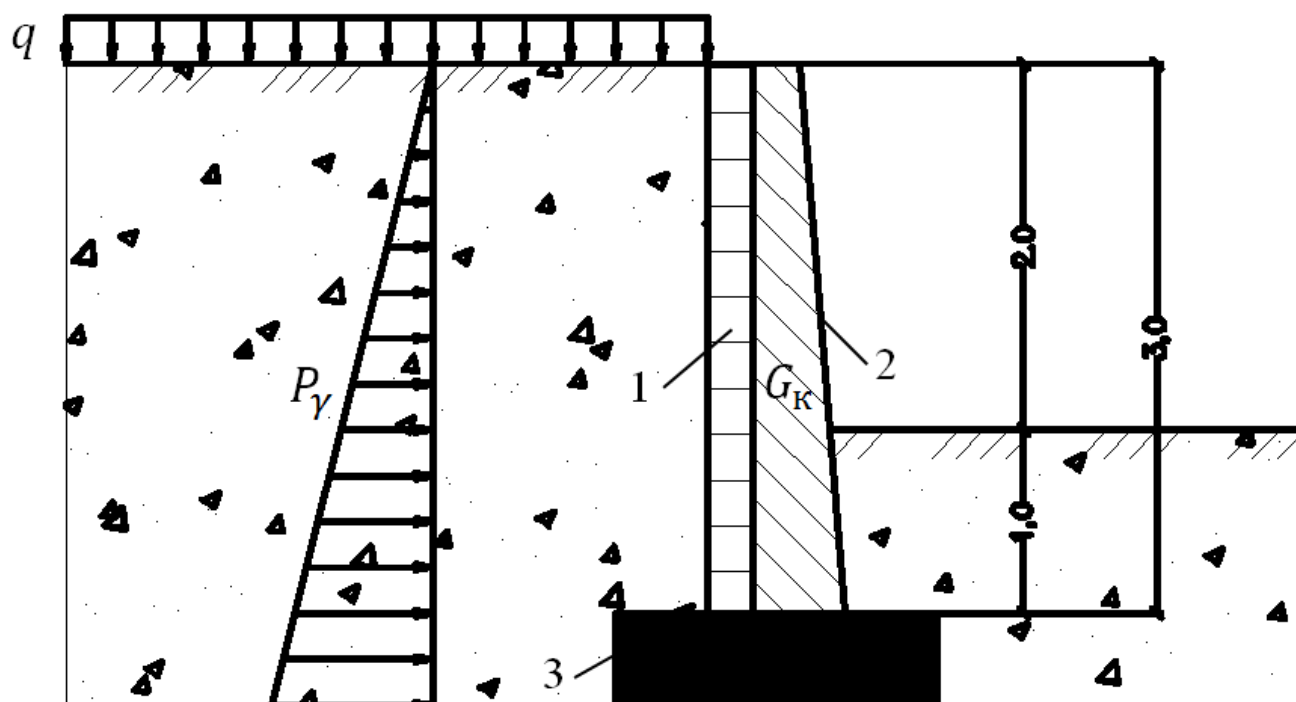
Расчетная схема: 1 – подпорная стенка; 2 – контрфорс; 3 – фундамент.
